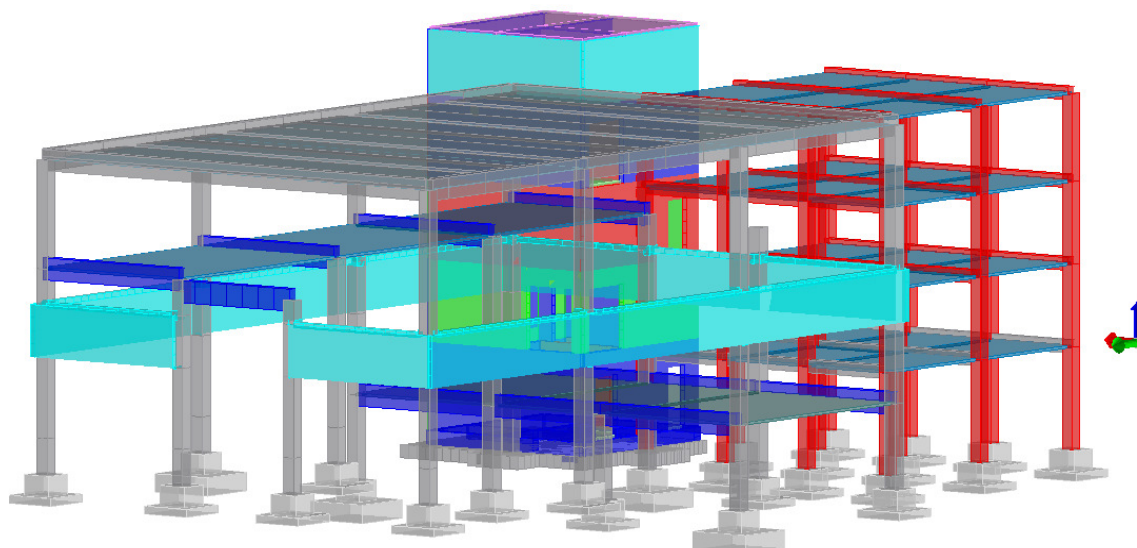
Vista degli elementi strutturali, prospetto NORD-EST - Modello FEM
